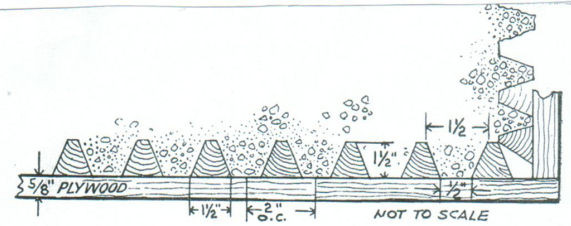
Detail van de bekisting voor de bruut te bewerken wanden.
